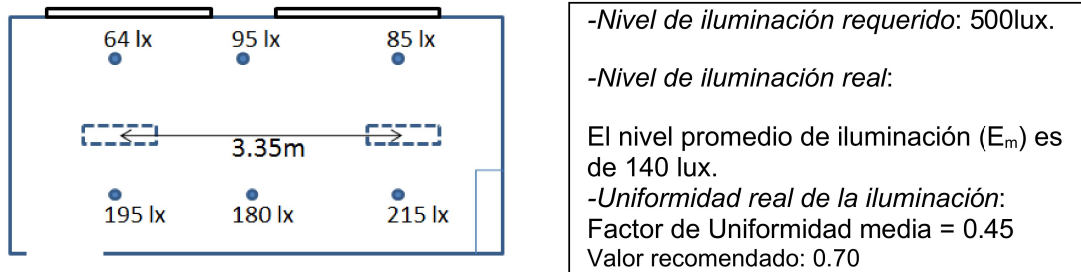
Planta esquemática aula 88, con medición de niveles de iluminación en lux
